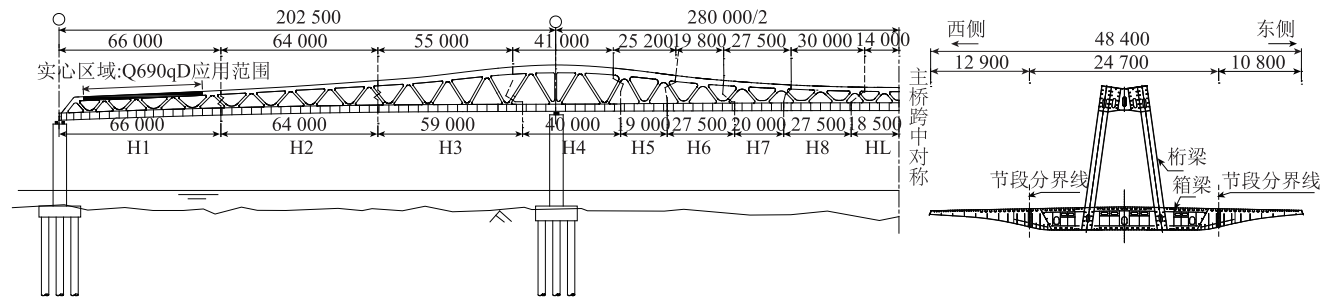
主桥桥型 (1 联 1/2 立面) (单位: mm)
